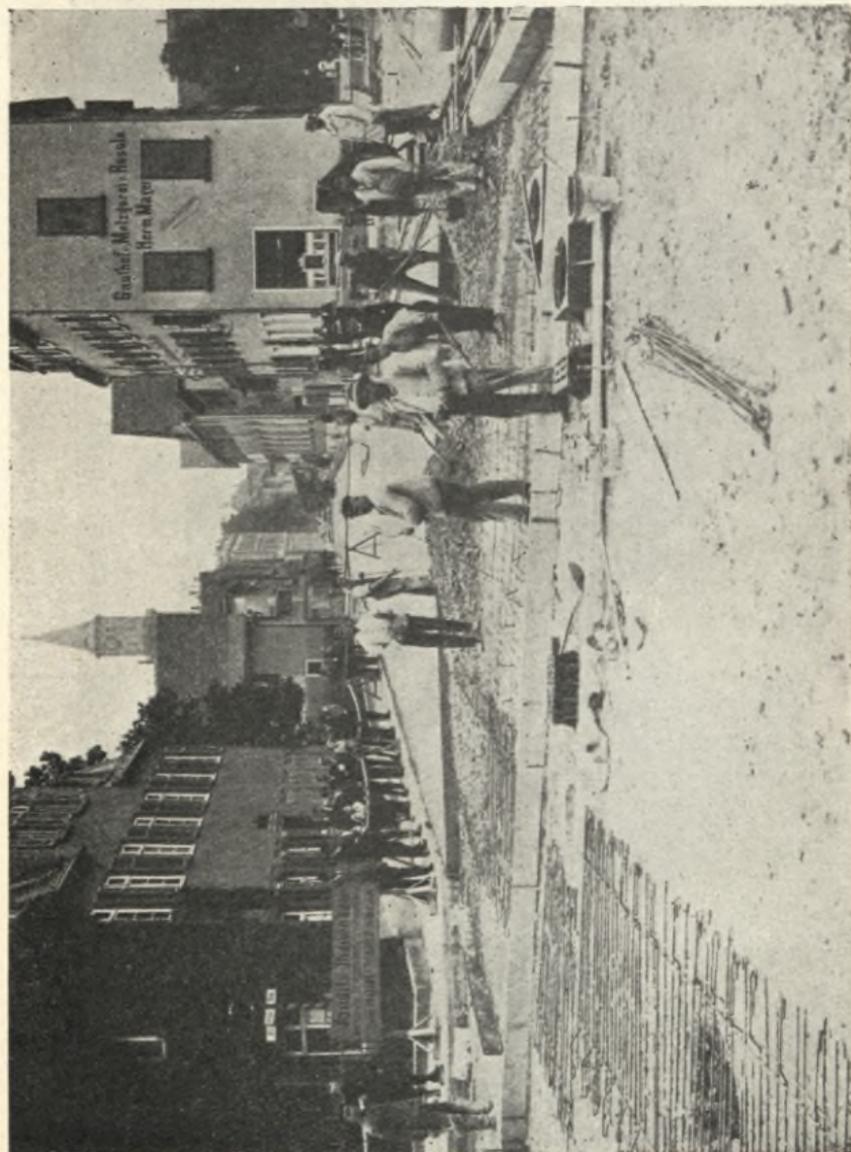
Stuttgarter Straße zu Göppingen. Überdeckung frisch eingefüllter Rohrgräben durch Eiseneinlagen.
